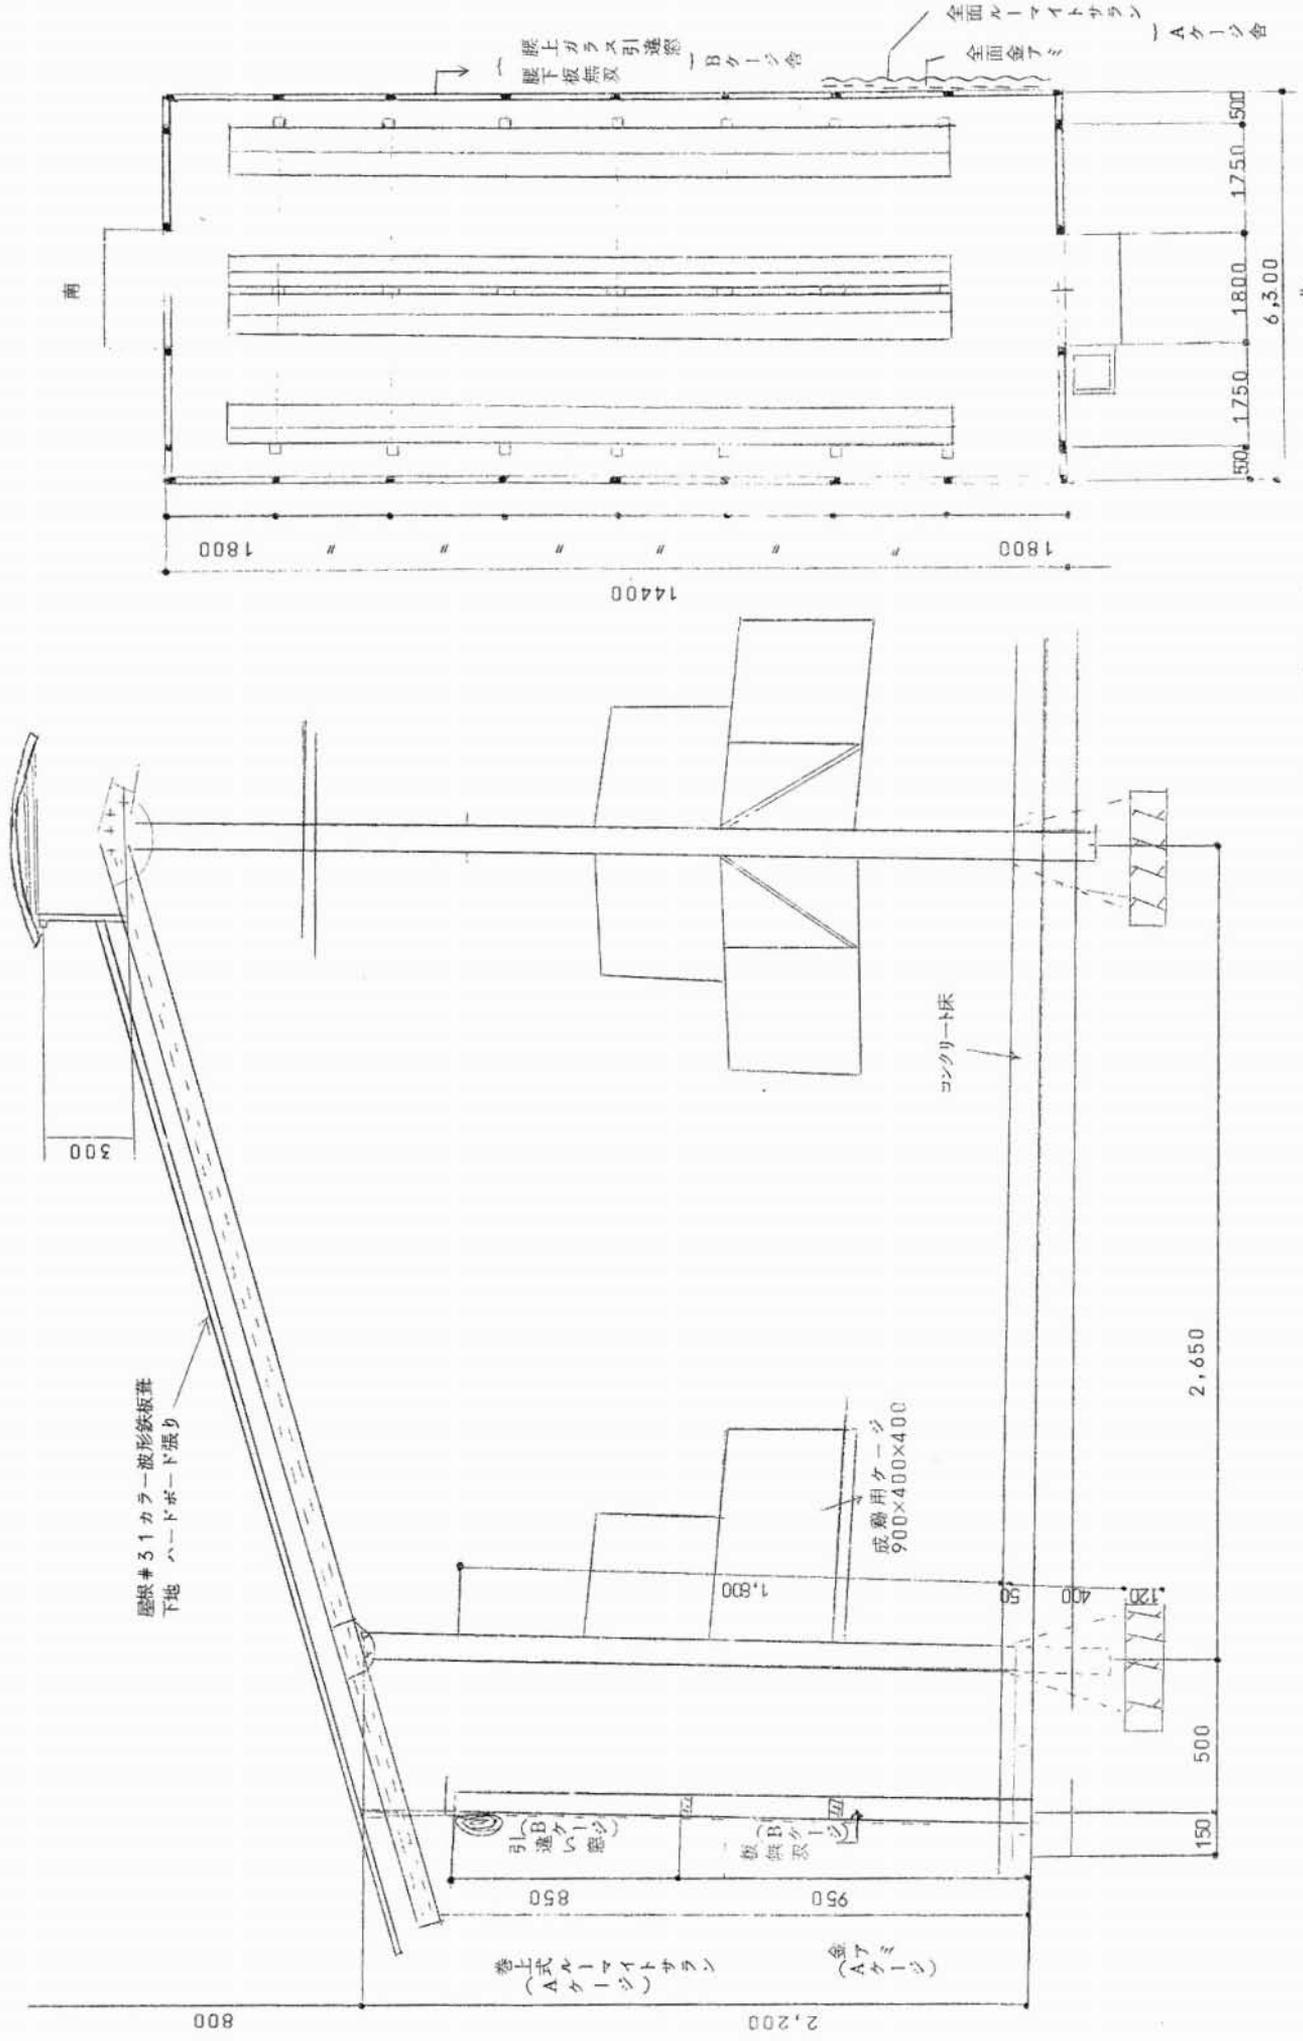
A・B ケージ 鶏舎 矩計図及び平面図 (単位: mm)
